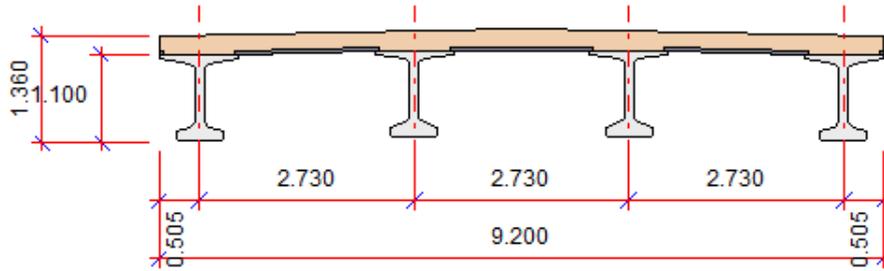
Vista en sección del tablero. Fuente: El. prop.
